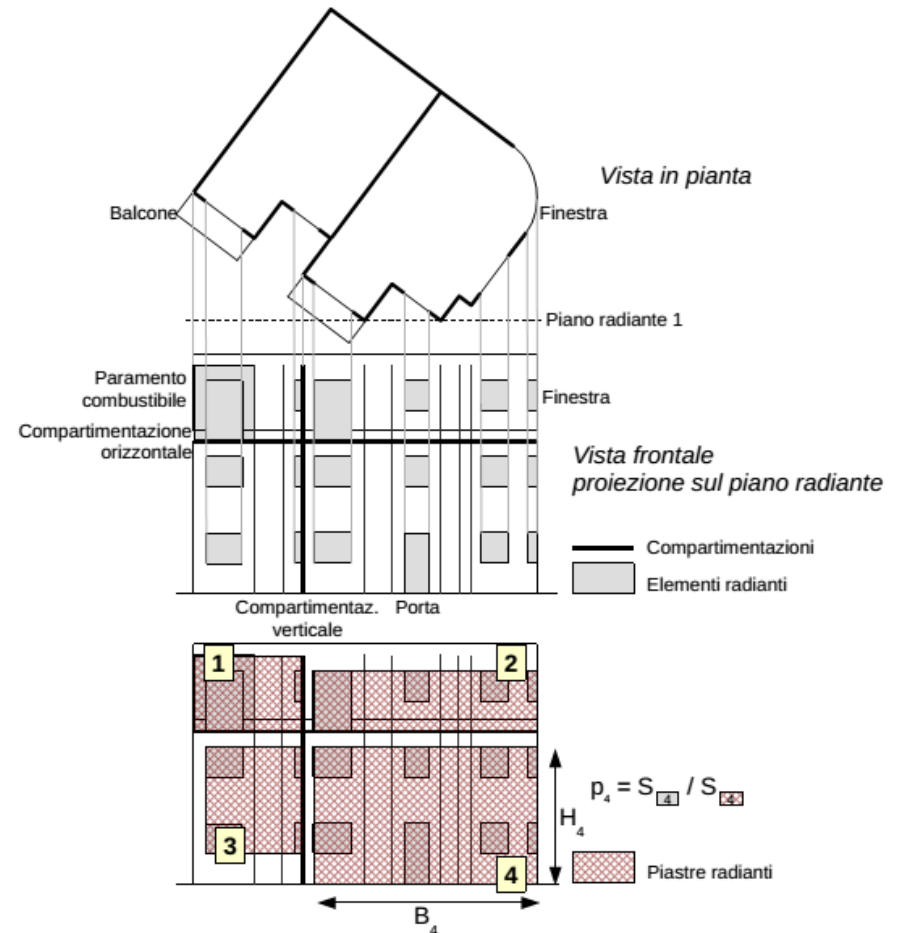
Determinazione del piano radiante (vista in pianta delle costruzioni)
